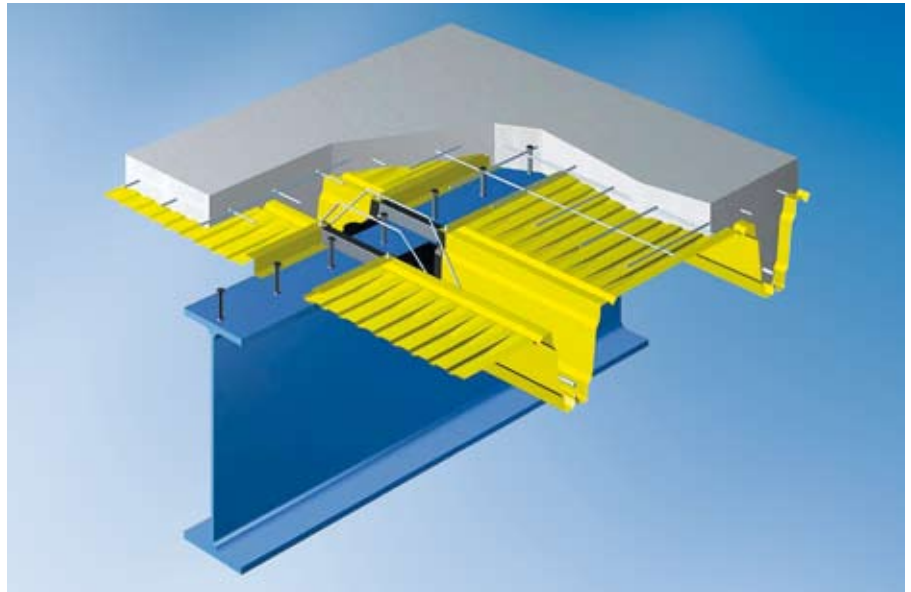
Prinzipdetails der Hoesch Additiv Decke®
